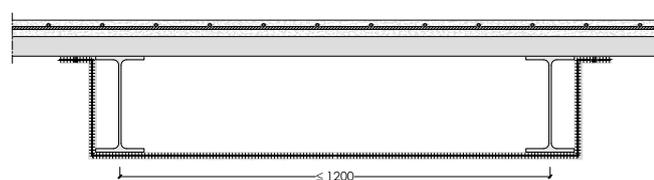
Schema di applicazione per protezione di più travi in carpenteria metallica (applicazione a box)
